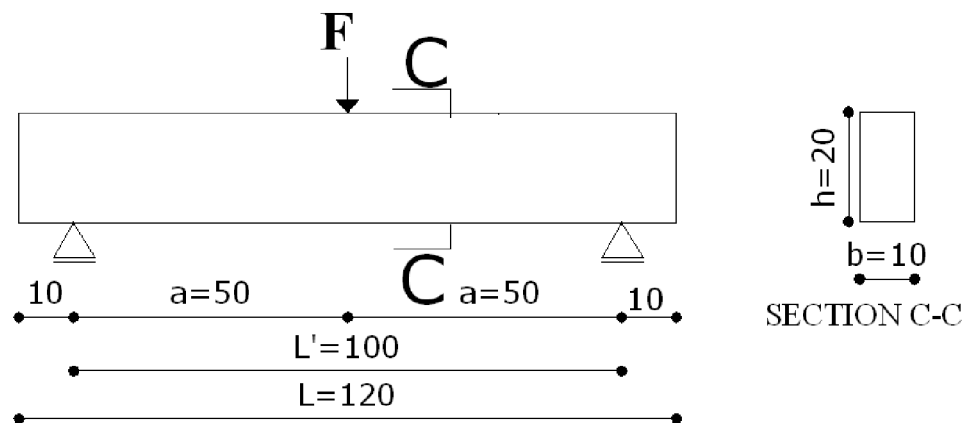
Schéma statique de l'essai de flexion 3- points.
